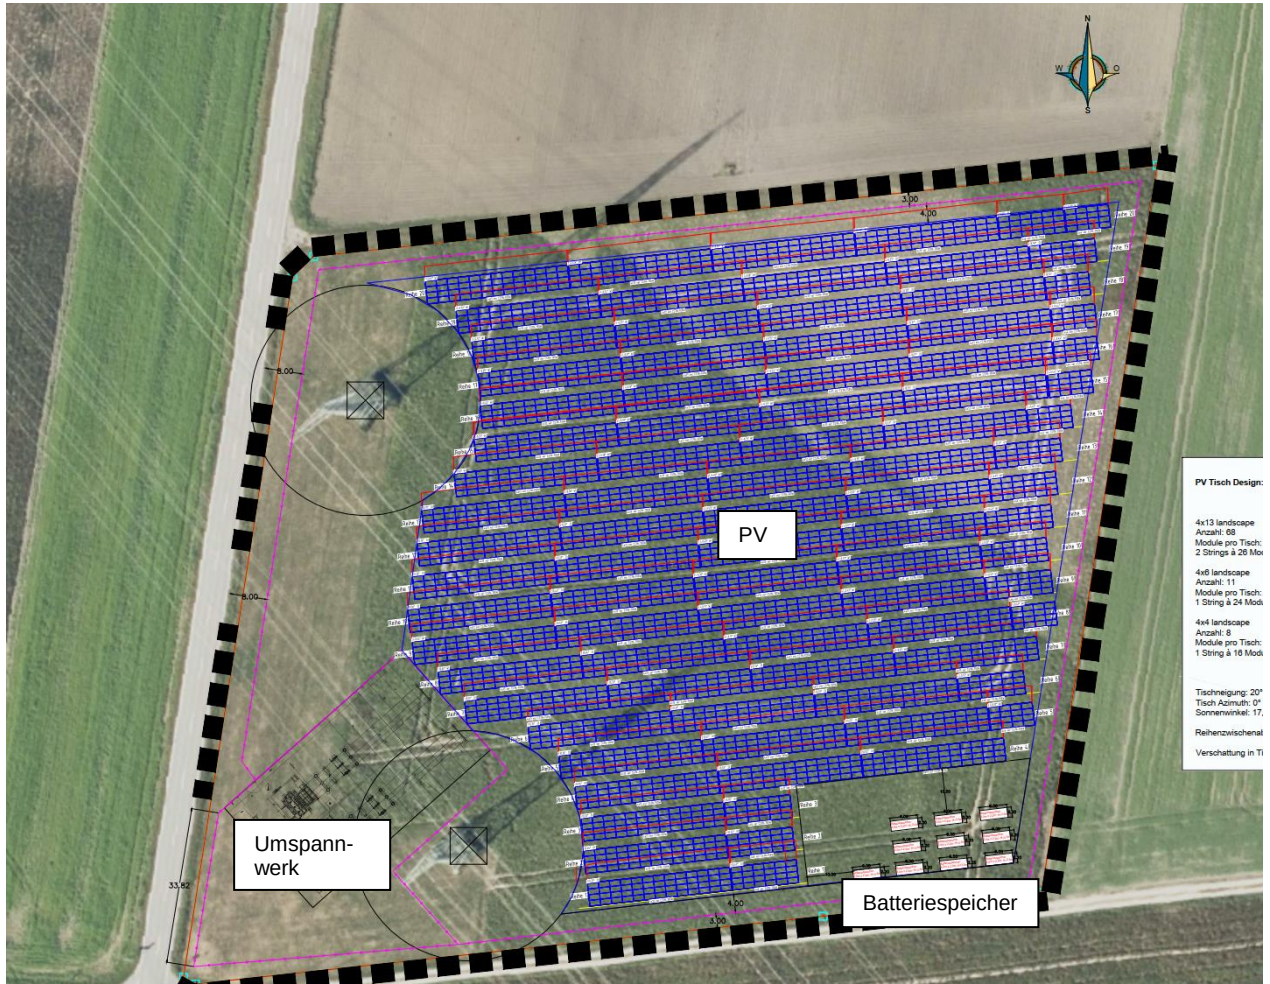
Lageplan Standortsituation mit PV-Anlage und Umspannwerk (unmaßstäblich, Quelle: SOLEA GmbH)
